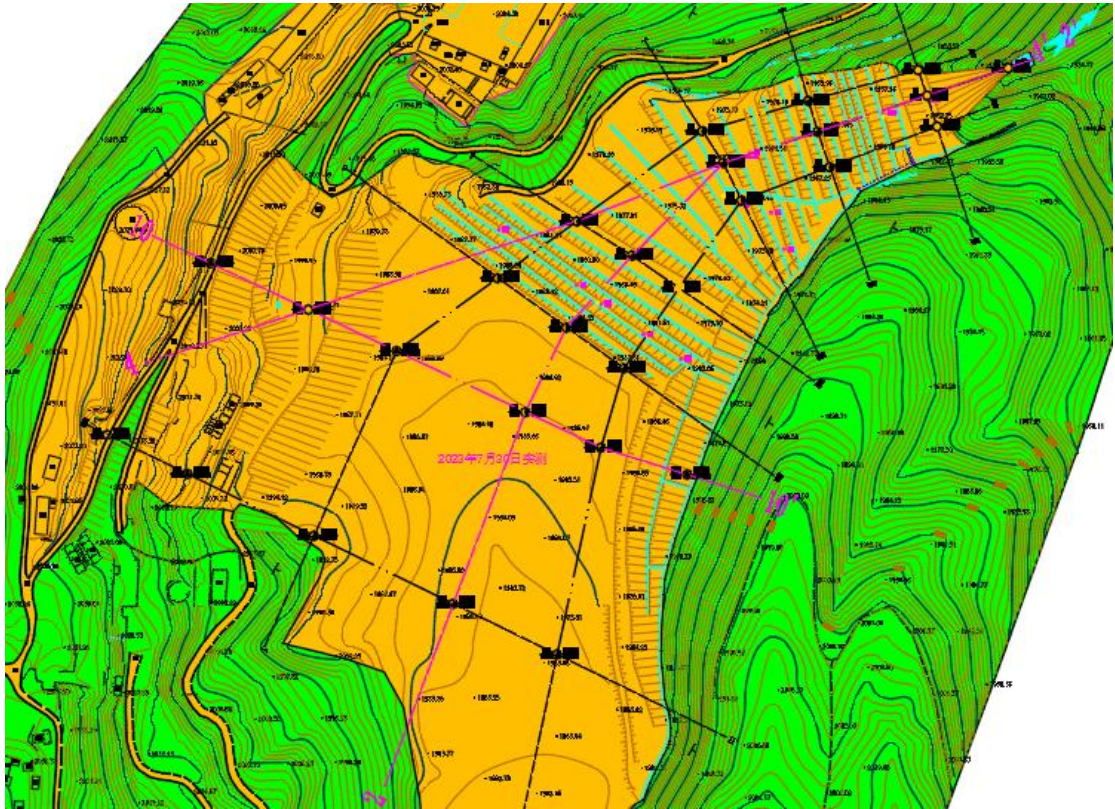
尾矿坝坝坡稳定分析剖面选取平面图
